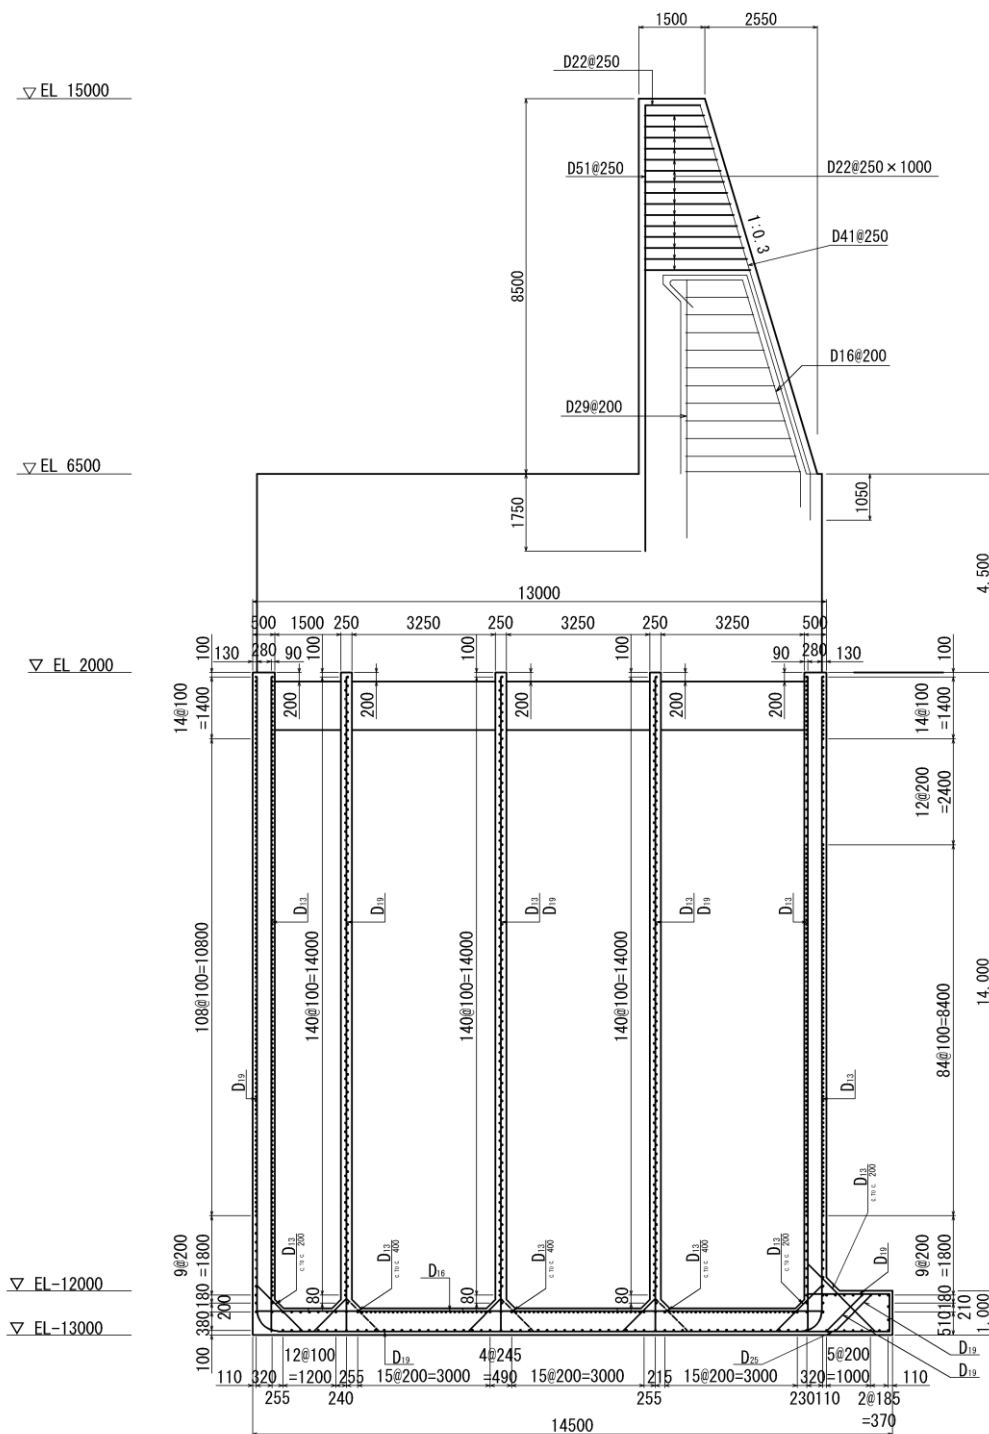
(1) 防波壁（波返重力擁壁）の重力擁壁及びケーソンの概略配筋図
